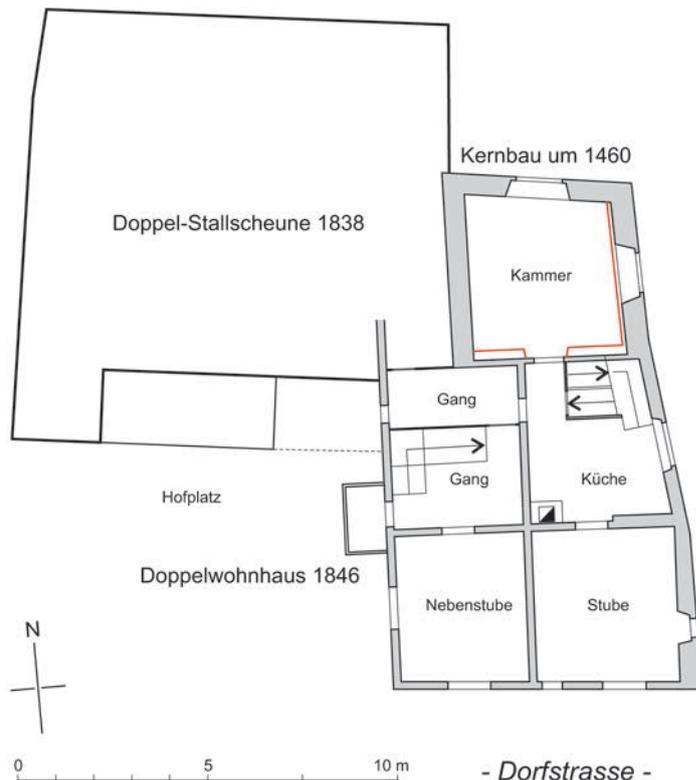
Grundriss Erdgeschoss. M. 1:200.
